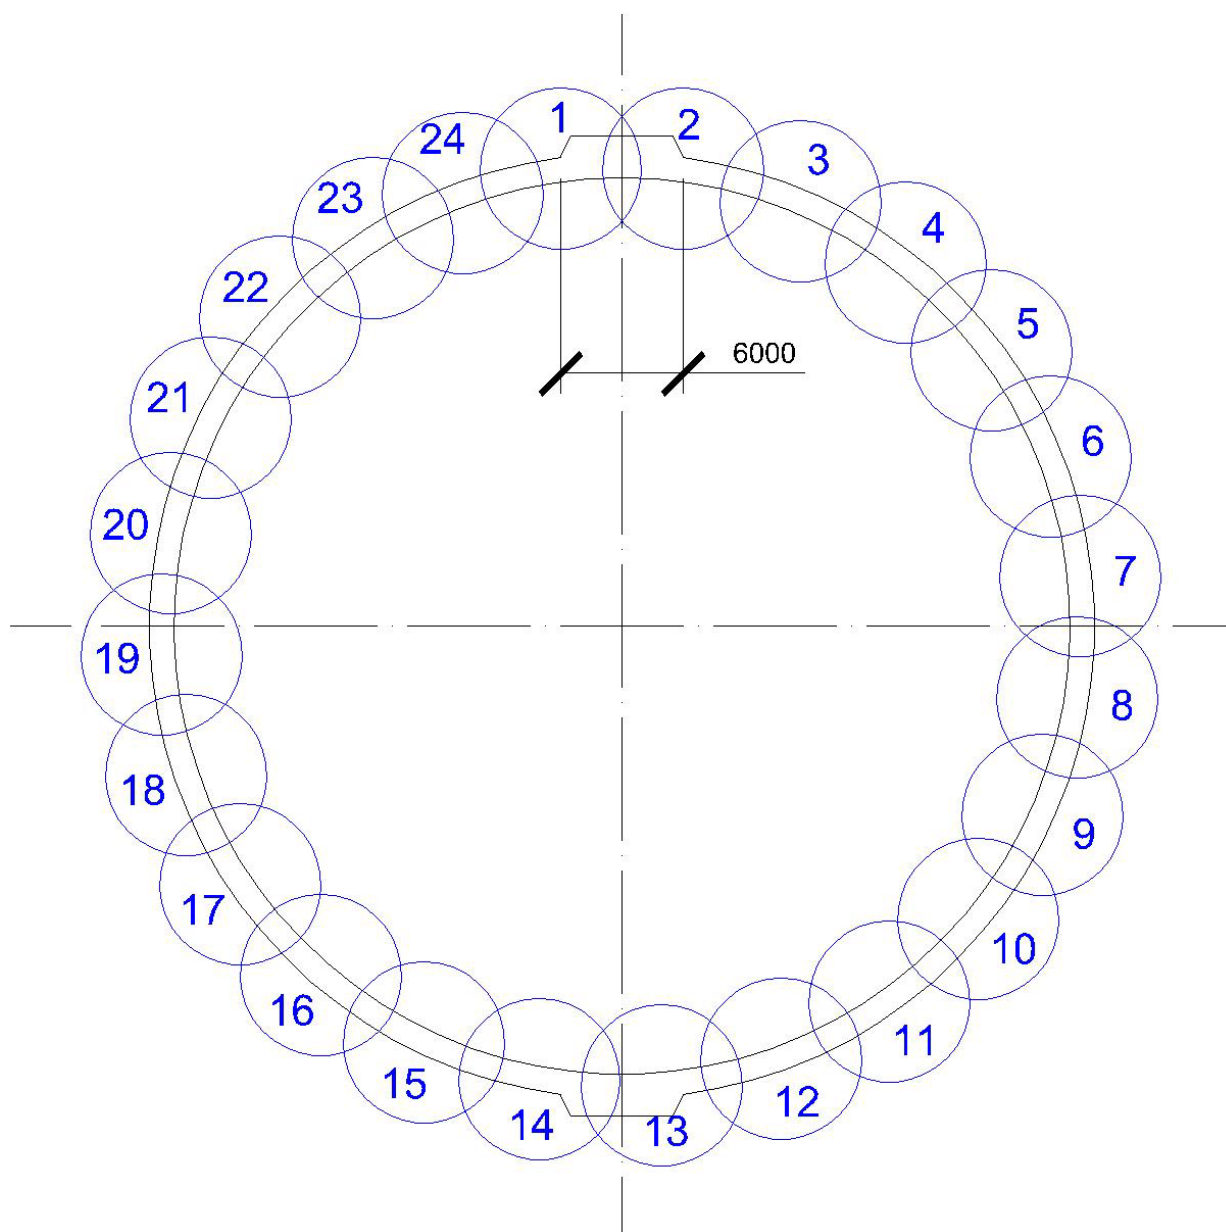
План-схема точек подачи бетонной смеси в ярус бетонирования
